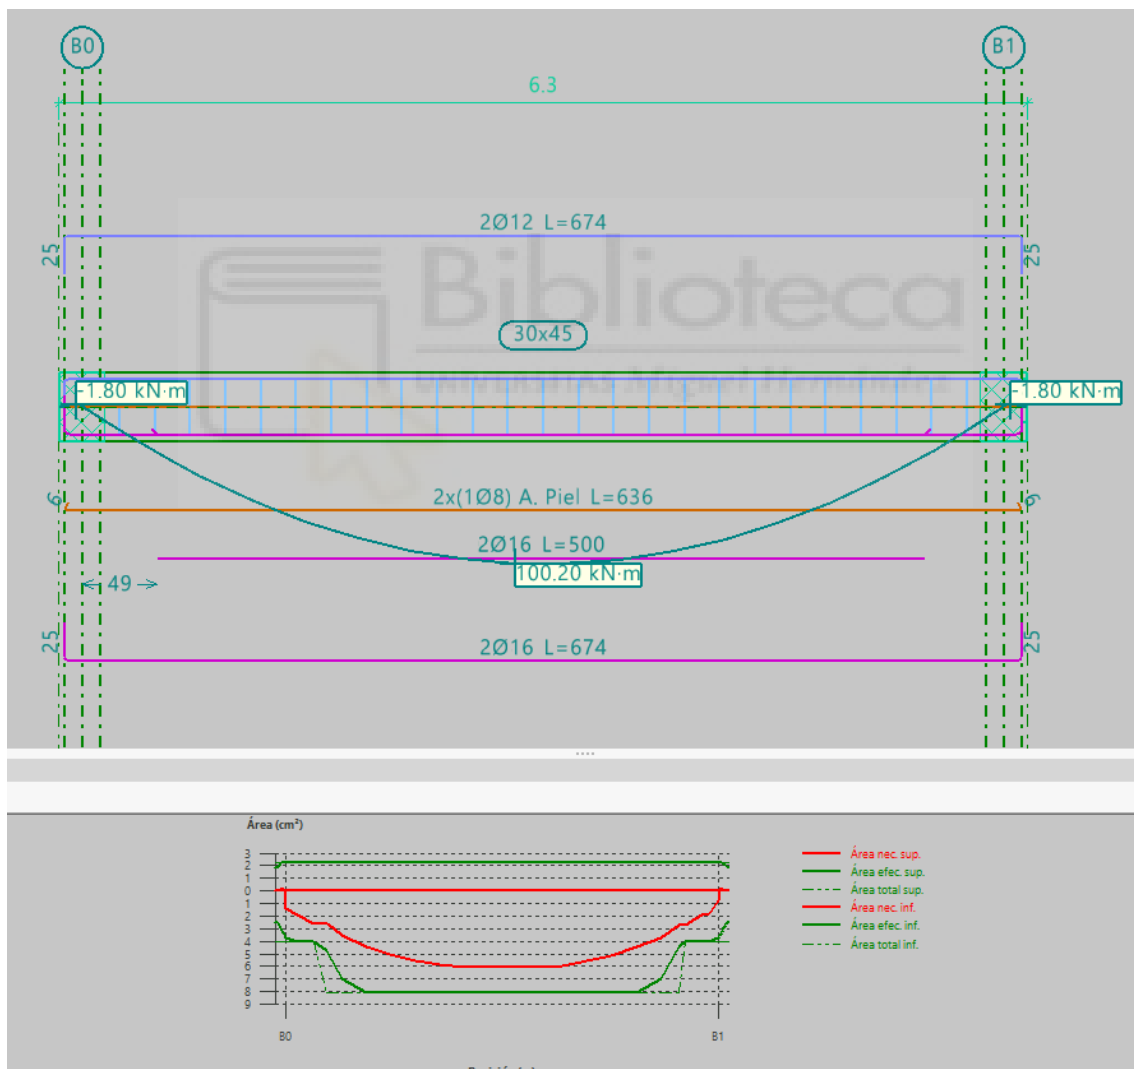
Esfuerzos y armado viga I2 con forjado
